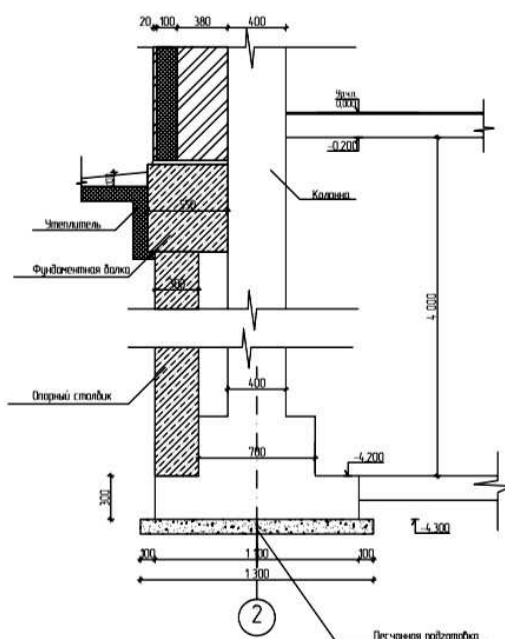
Сечение столбчатого фундамента Ф-2
